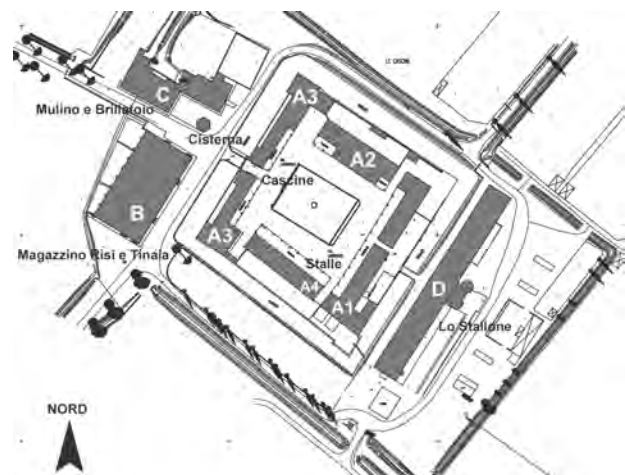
Corpi di fabbrica della fattoria- vista in pianta
